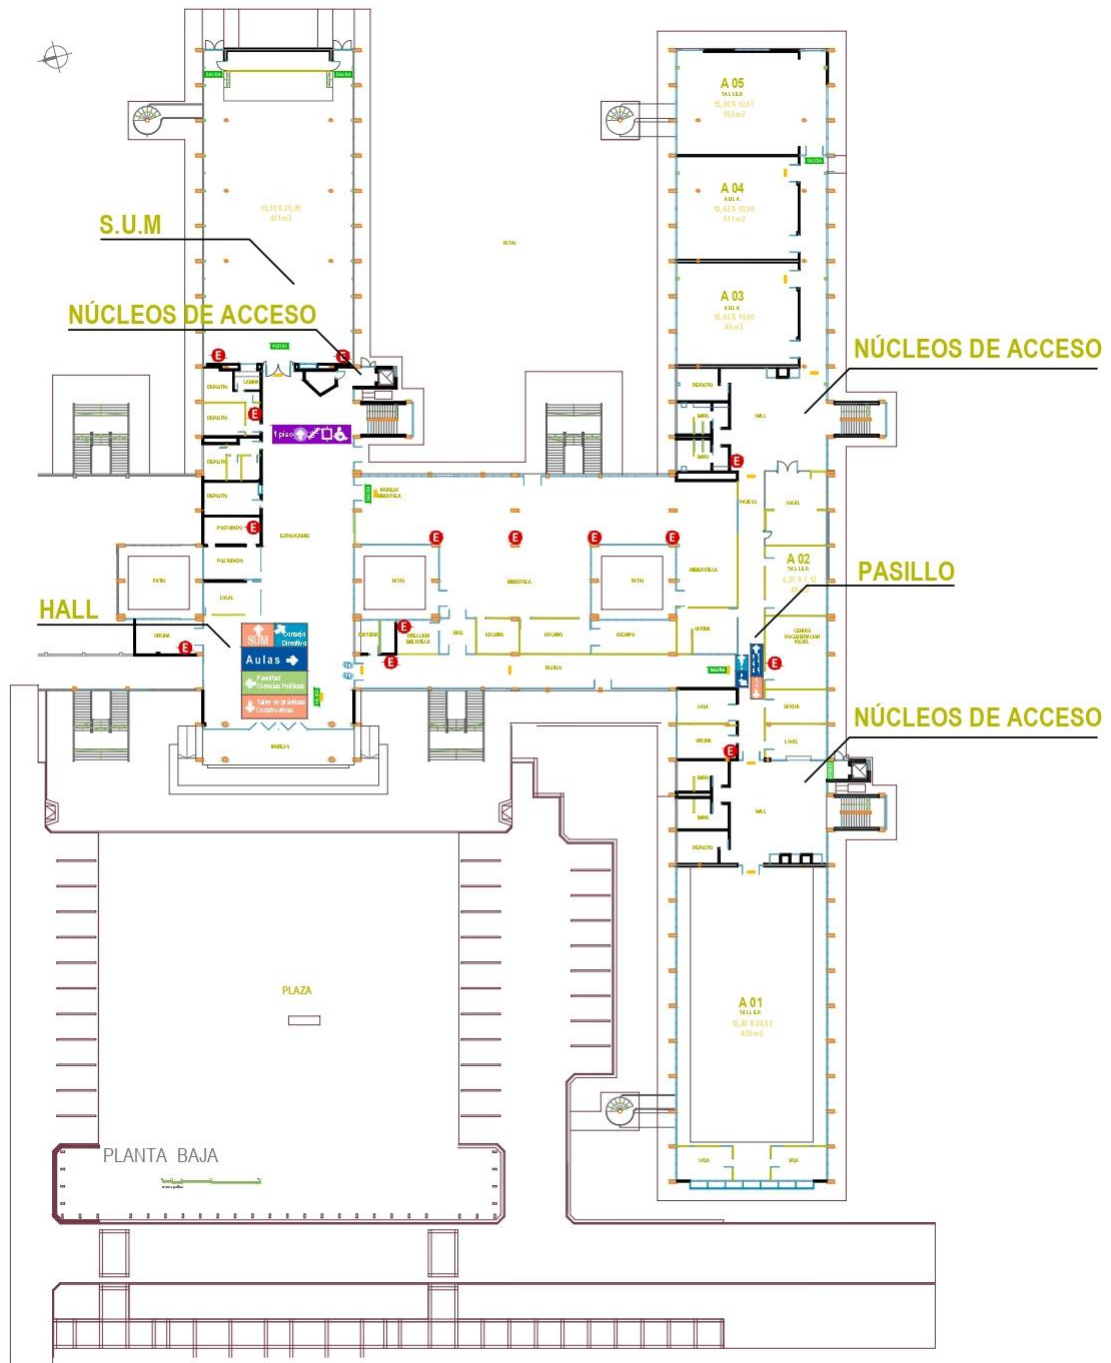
Plano planta baja edificio FAPyD. Fuente: elaboración propia.
